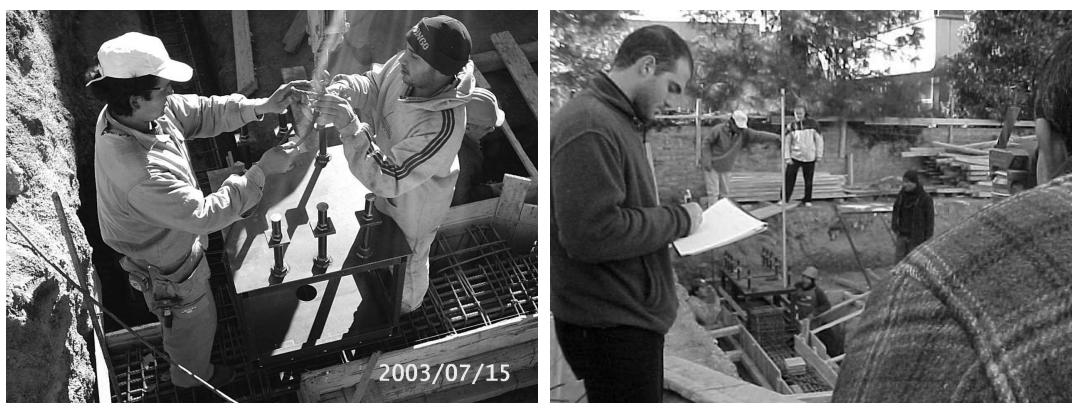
Control posicionamiento estructuras metálicas y de las platinas de anclaje.
